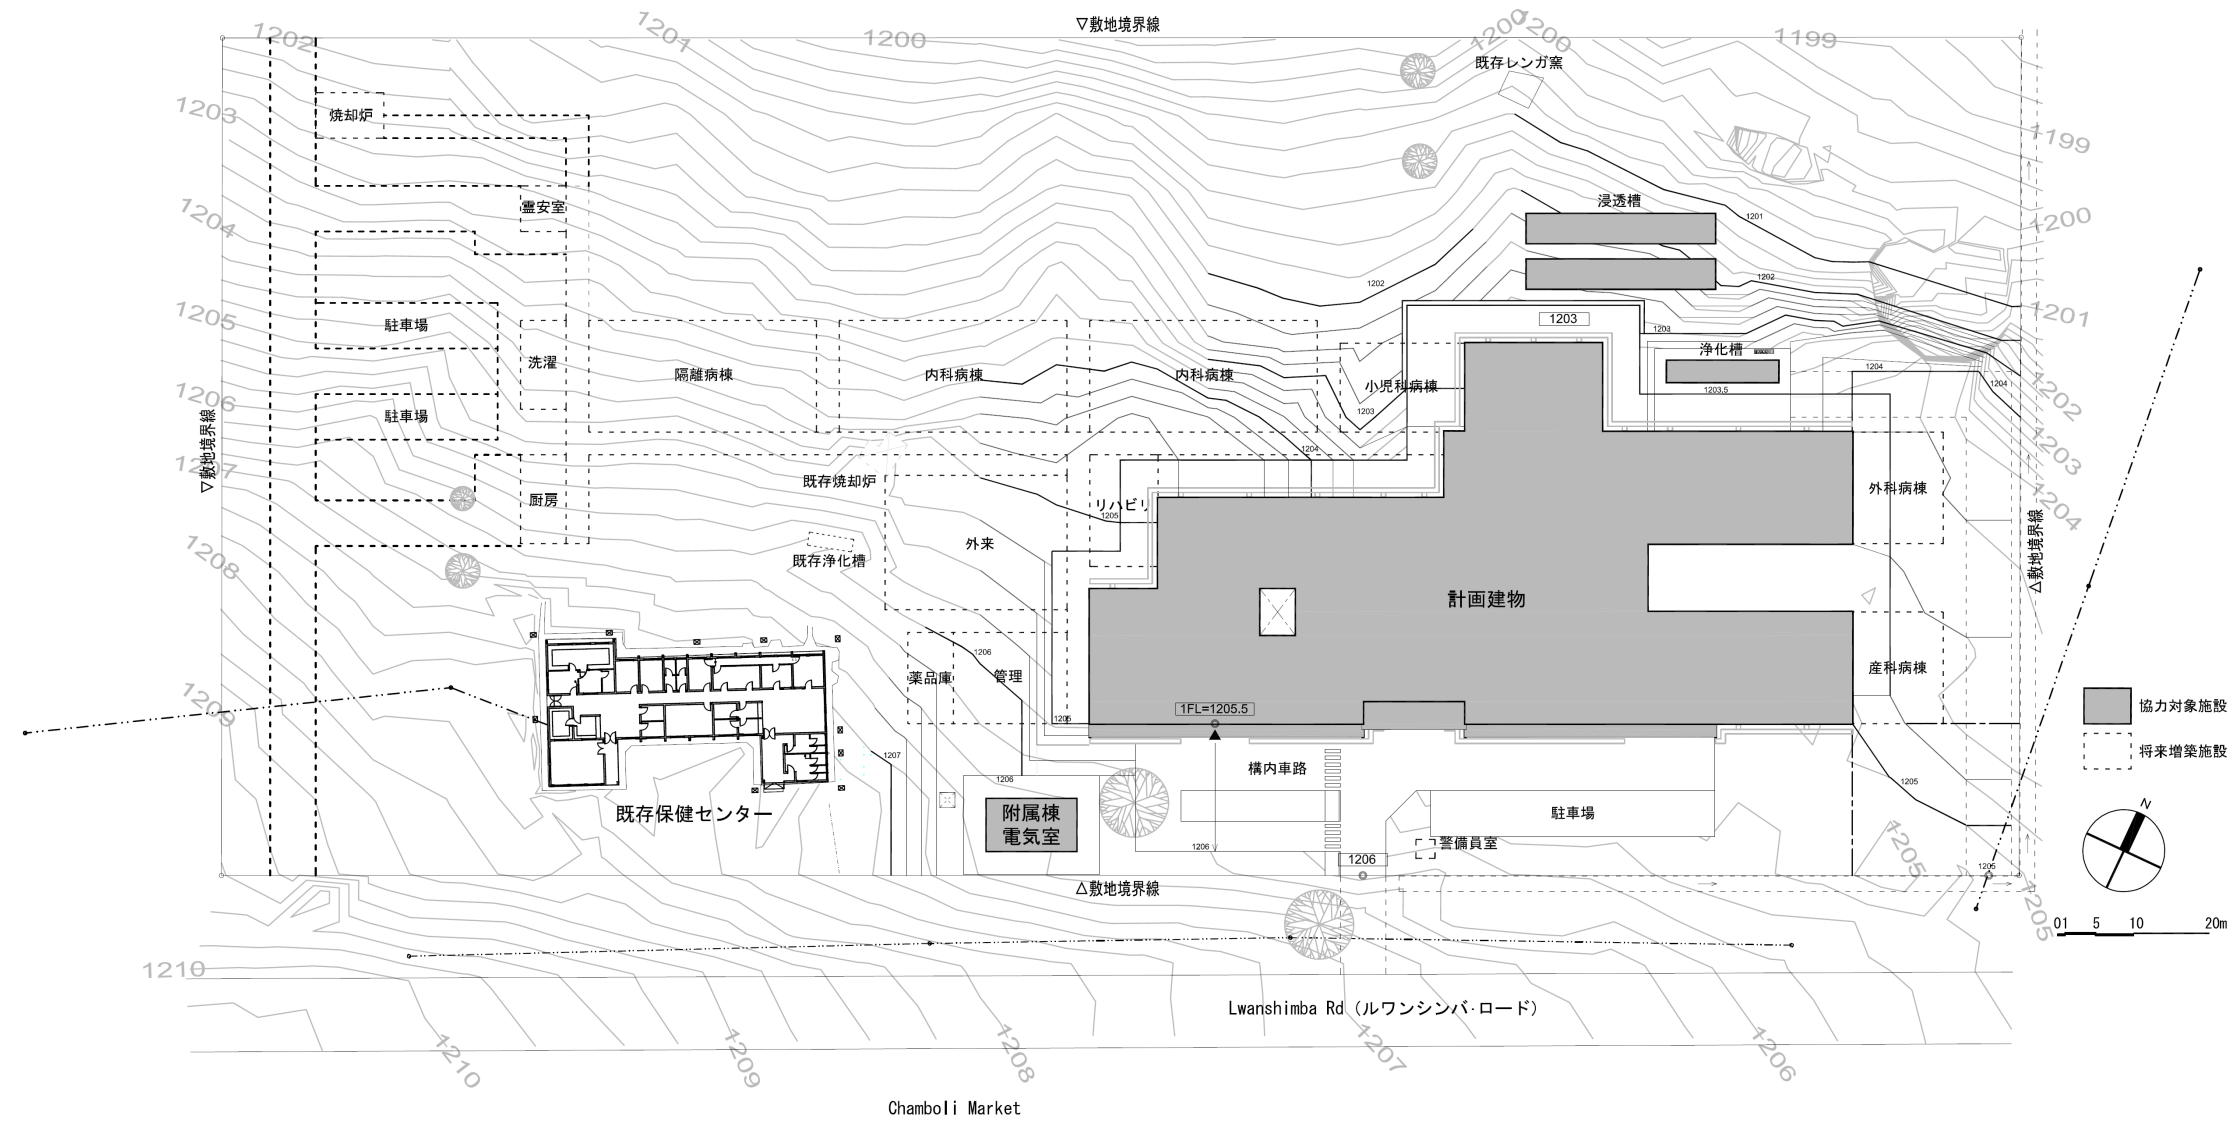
： チャンボリー一次レベル病院 配置図 1/1000
